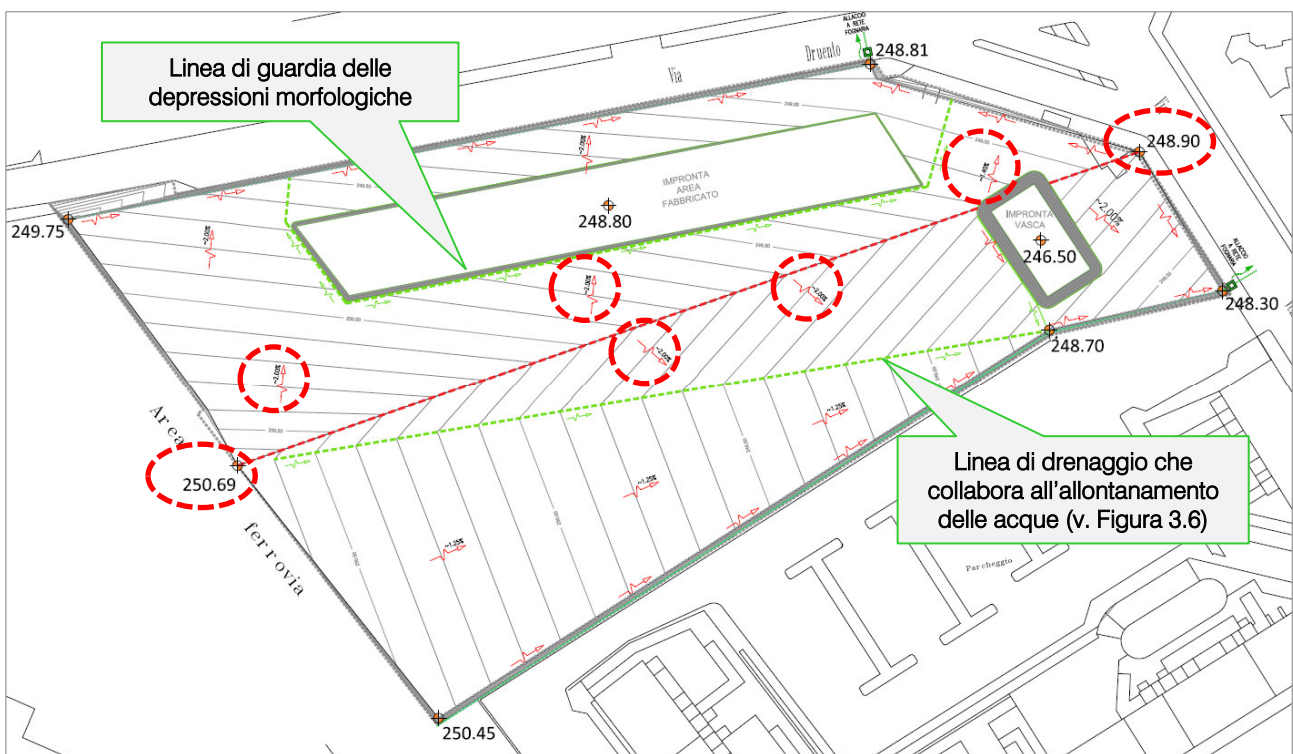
Planimetria piano di riprofilatura e deflusso delle acque di infiltrazione
